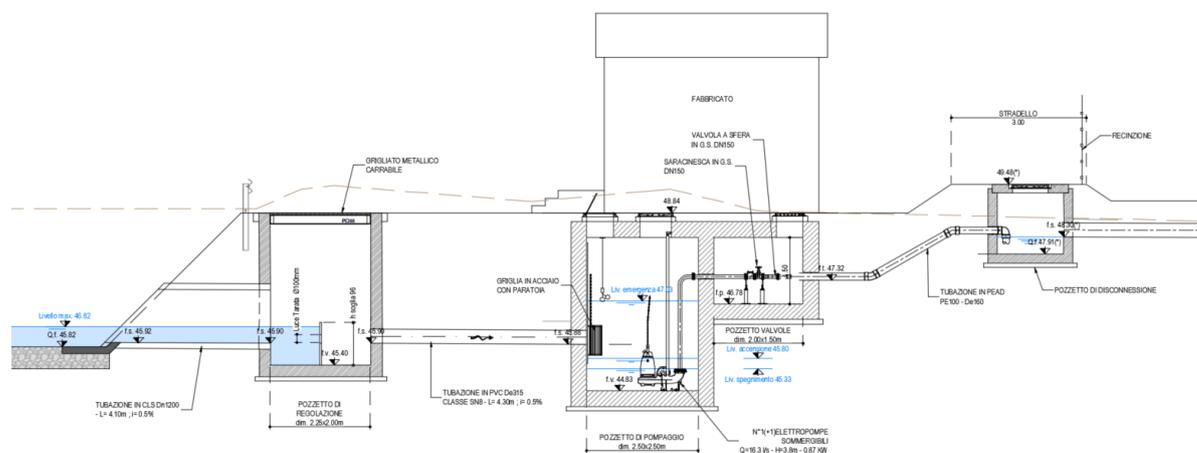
Pozzetto di regolazione, pozzetto pompe , pozzetto valvole e pozzetto di disconnessione - Sezione
